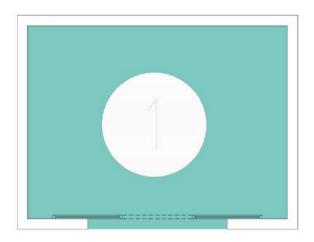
Planta 1 Bloque 40. Fuente: Equipo de diagnóstico.
